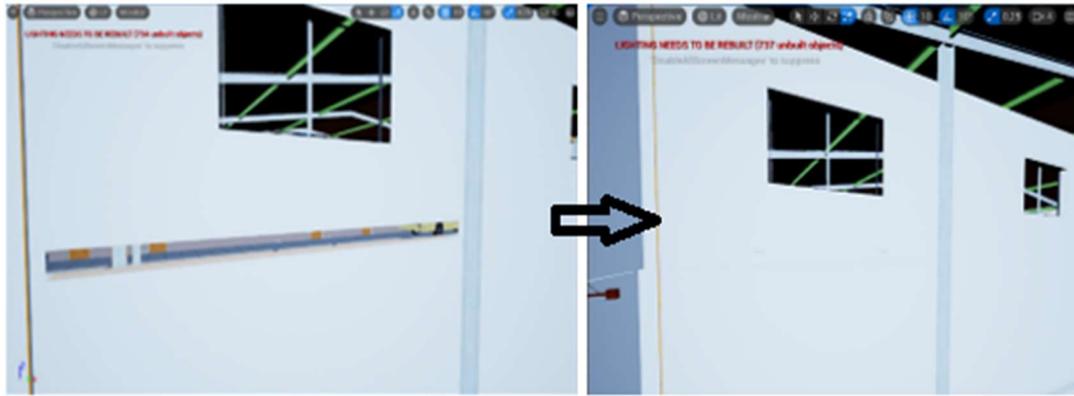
Arreglos estructurales en muros. Fuente: Elaboración propia.
